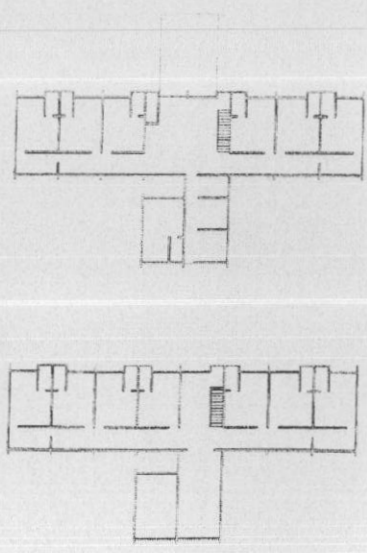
Croqui da planta baixa da casa de hóspedes do Campus II (pavimento inferior e superior)
